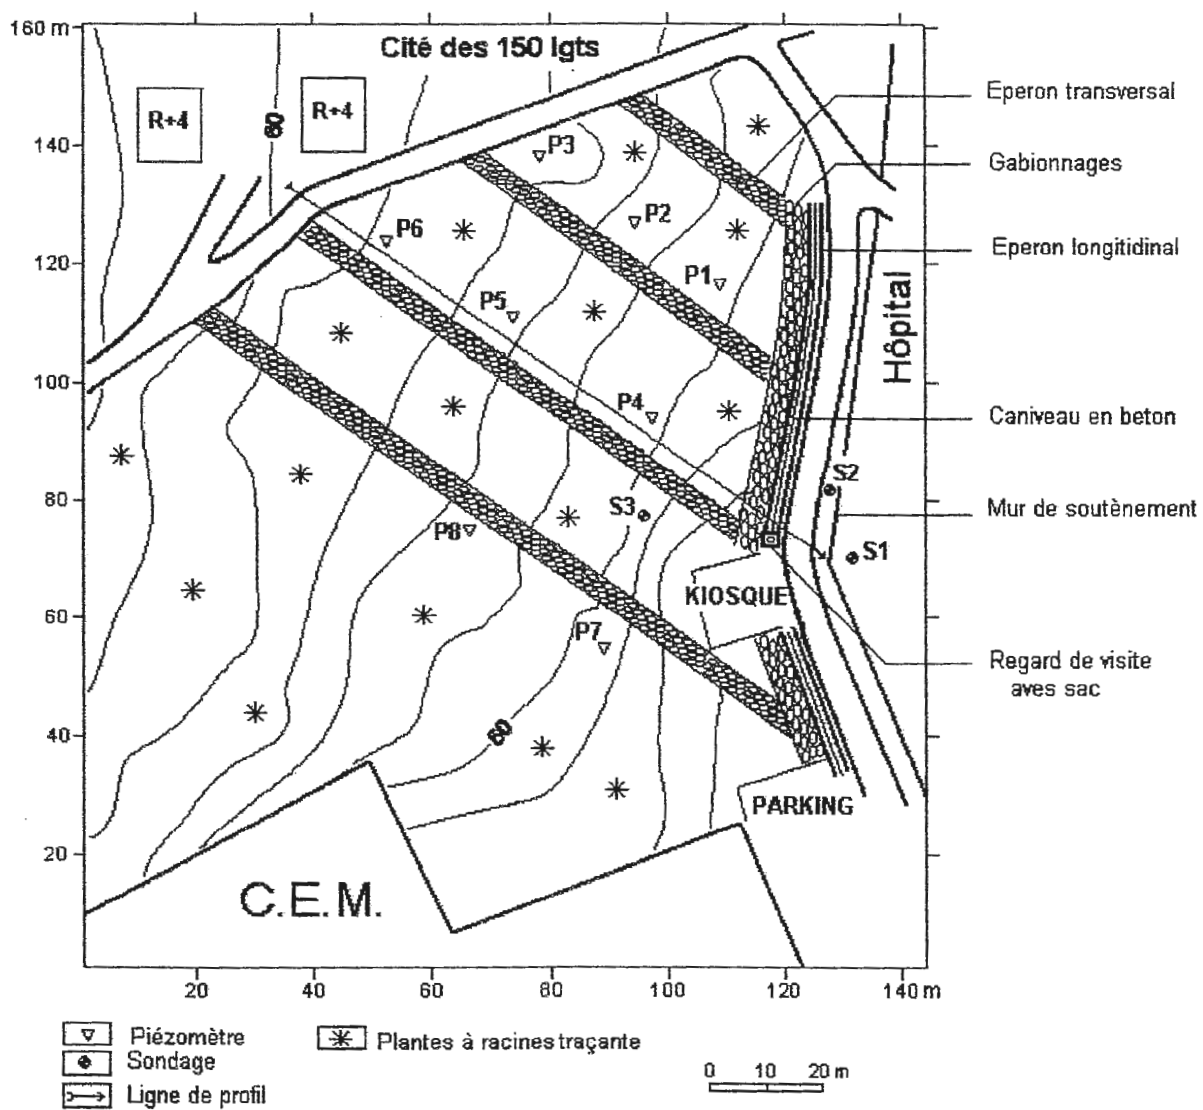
Plan d'intervention et proposition de solutions relatives au drainage, gabionnage, mur de soutènement et reboisement.
